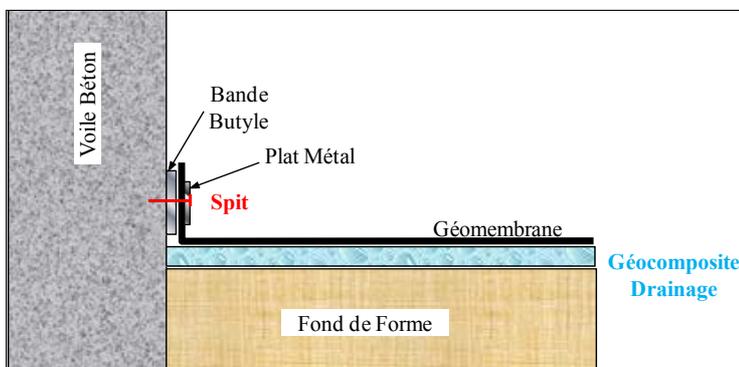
Bande d'étanchéité sous remontée de la géomembrane
